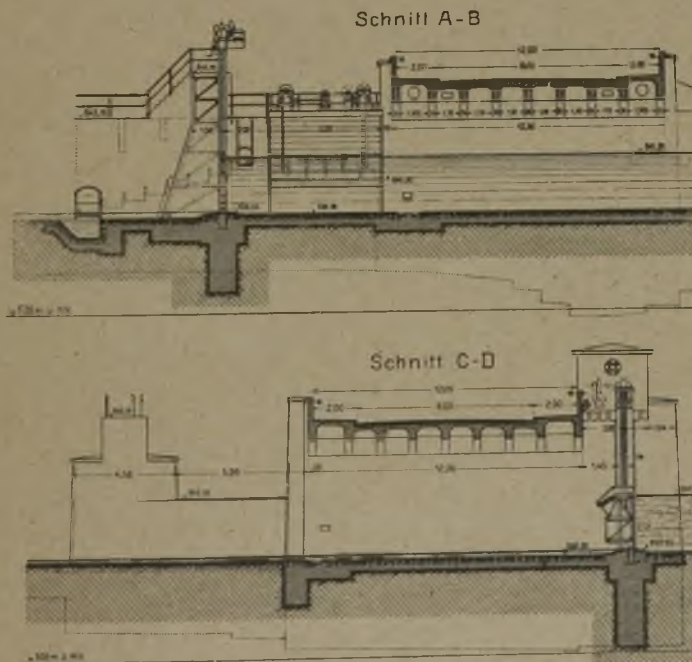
Donau-Brücke in Tuttingen in Verbindung mit Stauwehr. Erbaut 1913-1914.
